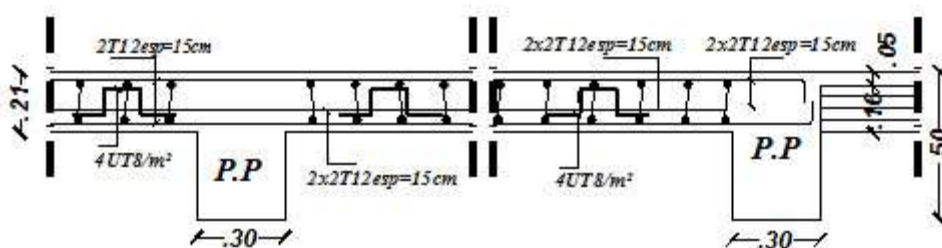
Ferrailage de dalle pleine eps=21 cm
